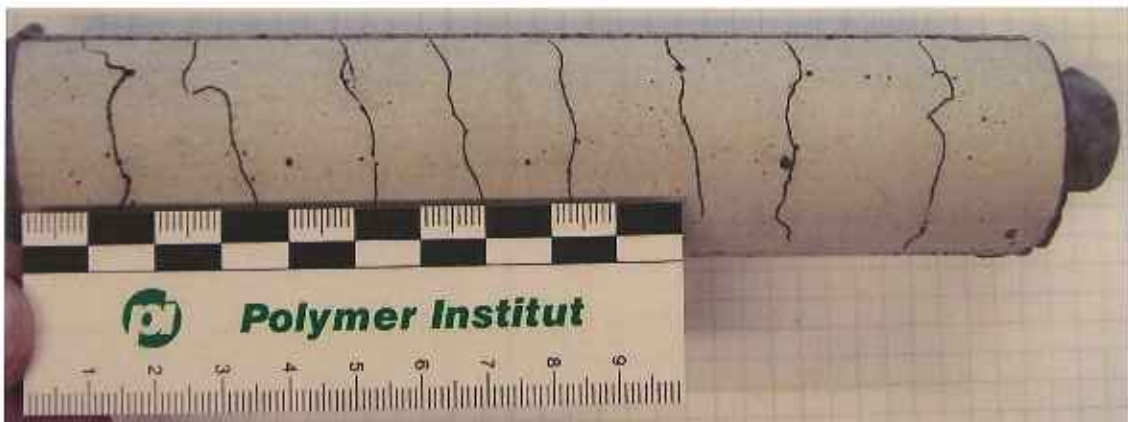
Probekörper nach Bewitterung. Rissabstände 10 - 20 mm, Rissbreite \ll 0,05 mm - mit schwarzem Feinliner nachgezeichnet
